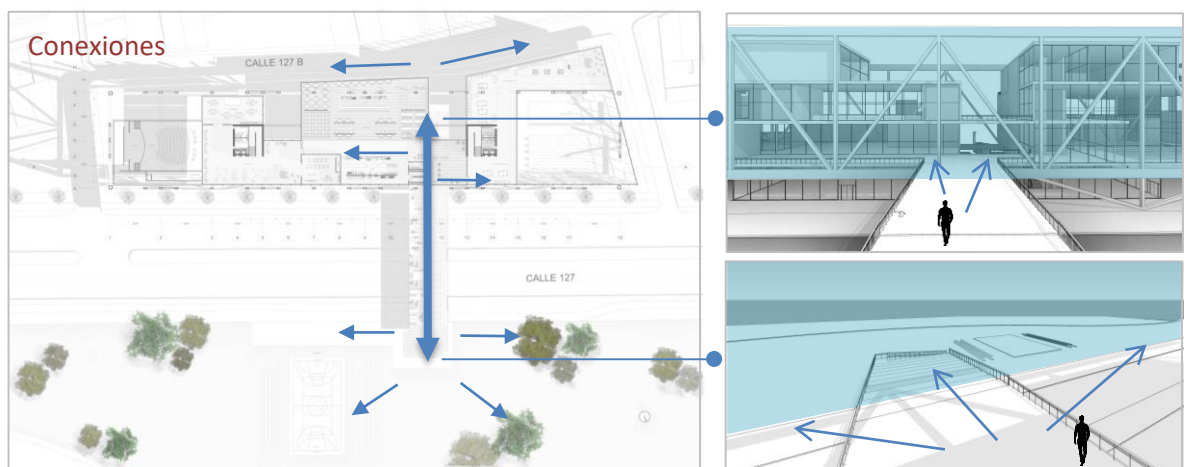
Planta Segundo Piso (Fuente: elaboración propia)
